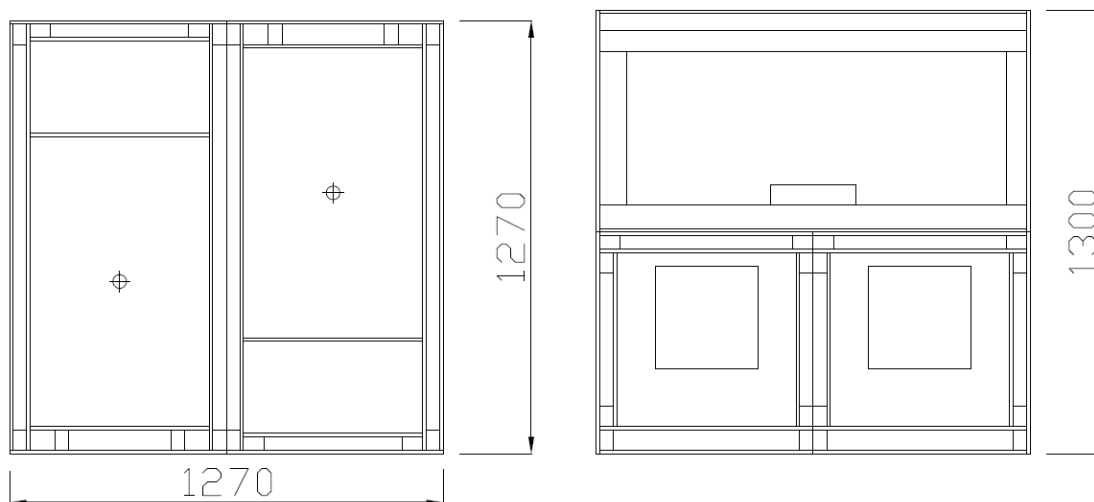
Půdorys plánovaného modelu pro měření základní varianta a varianta s možnou úpravou
